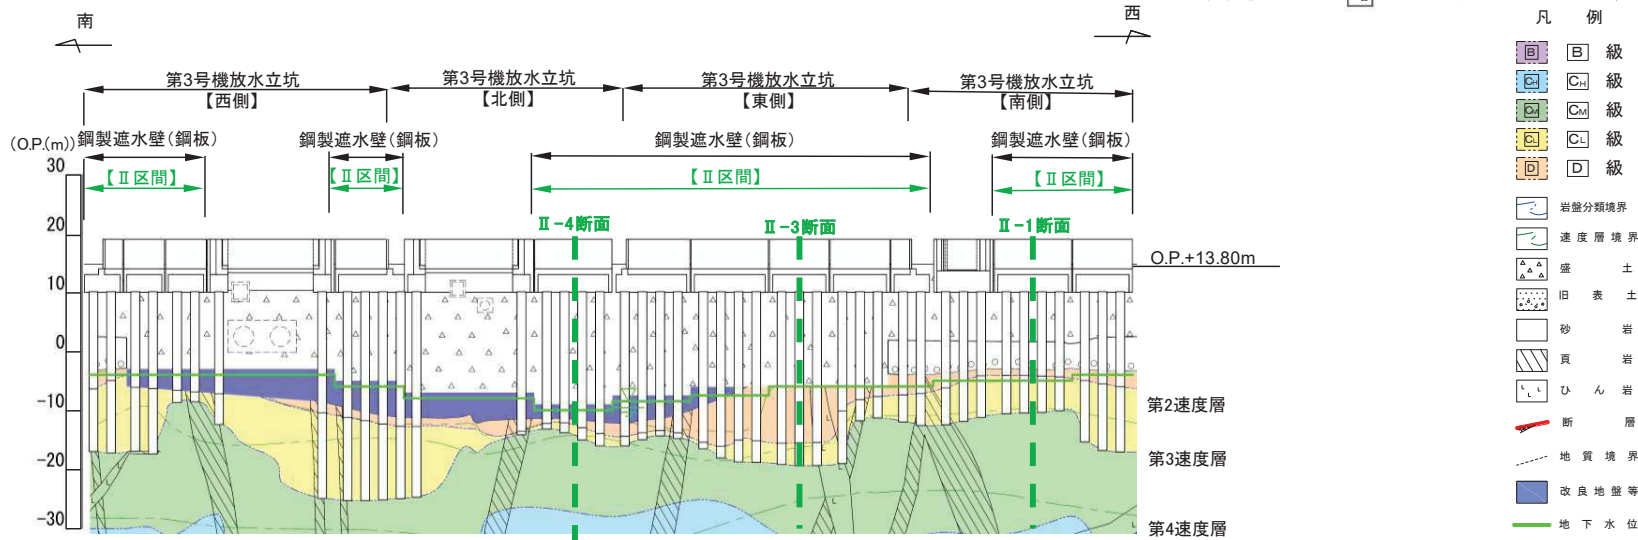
(4) 評価候補断面の地質縦断図 (第3号機放水立坑)
